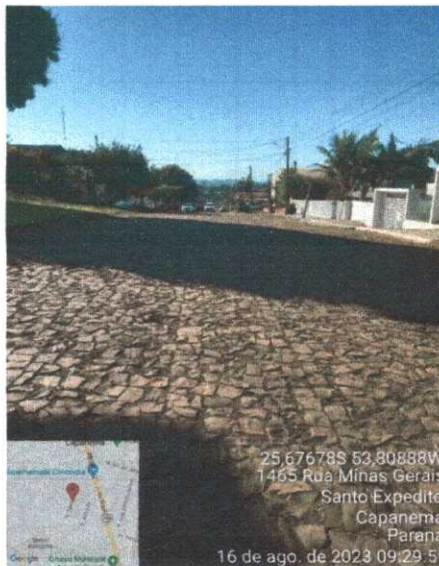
Fim do Trecho da Rua Otávio Kischner, cruzamento com
